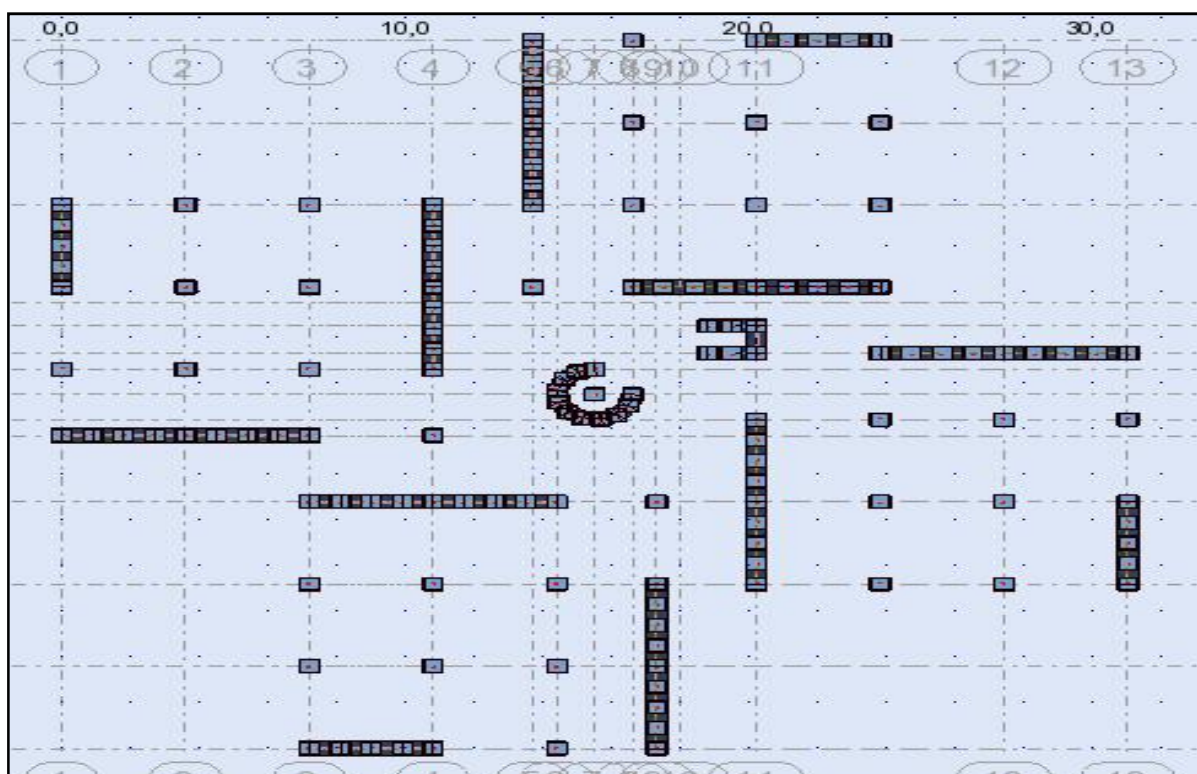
La 3ème disposition des murs voiles et poteaux
